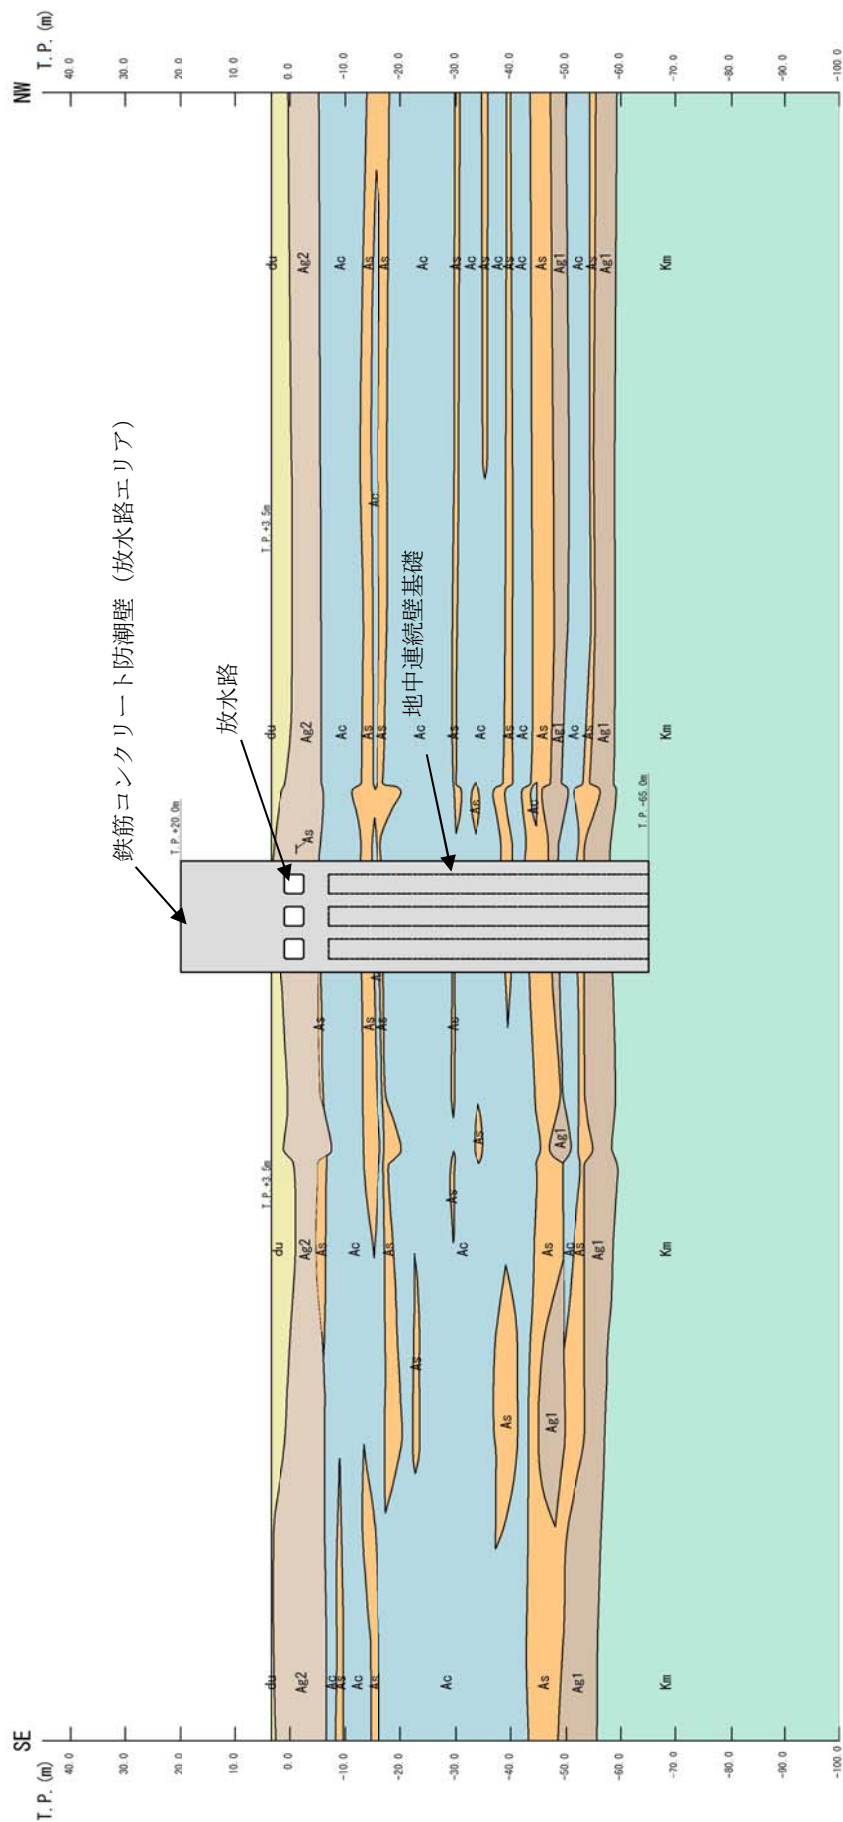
(2) 鉄筋コンクリート防潮壁 (放水路エリア) の評価対象断面図 (防潮壁縦断方向：②-②断面, 防潮壁部)
